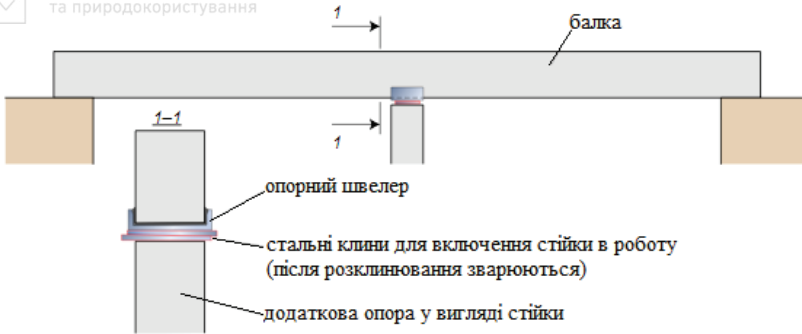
Підсилення залізобетонних балок підведенням розвантажувальних стійок
